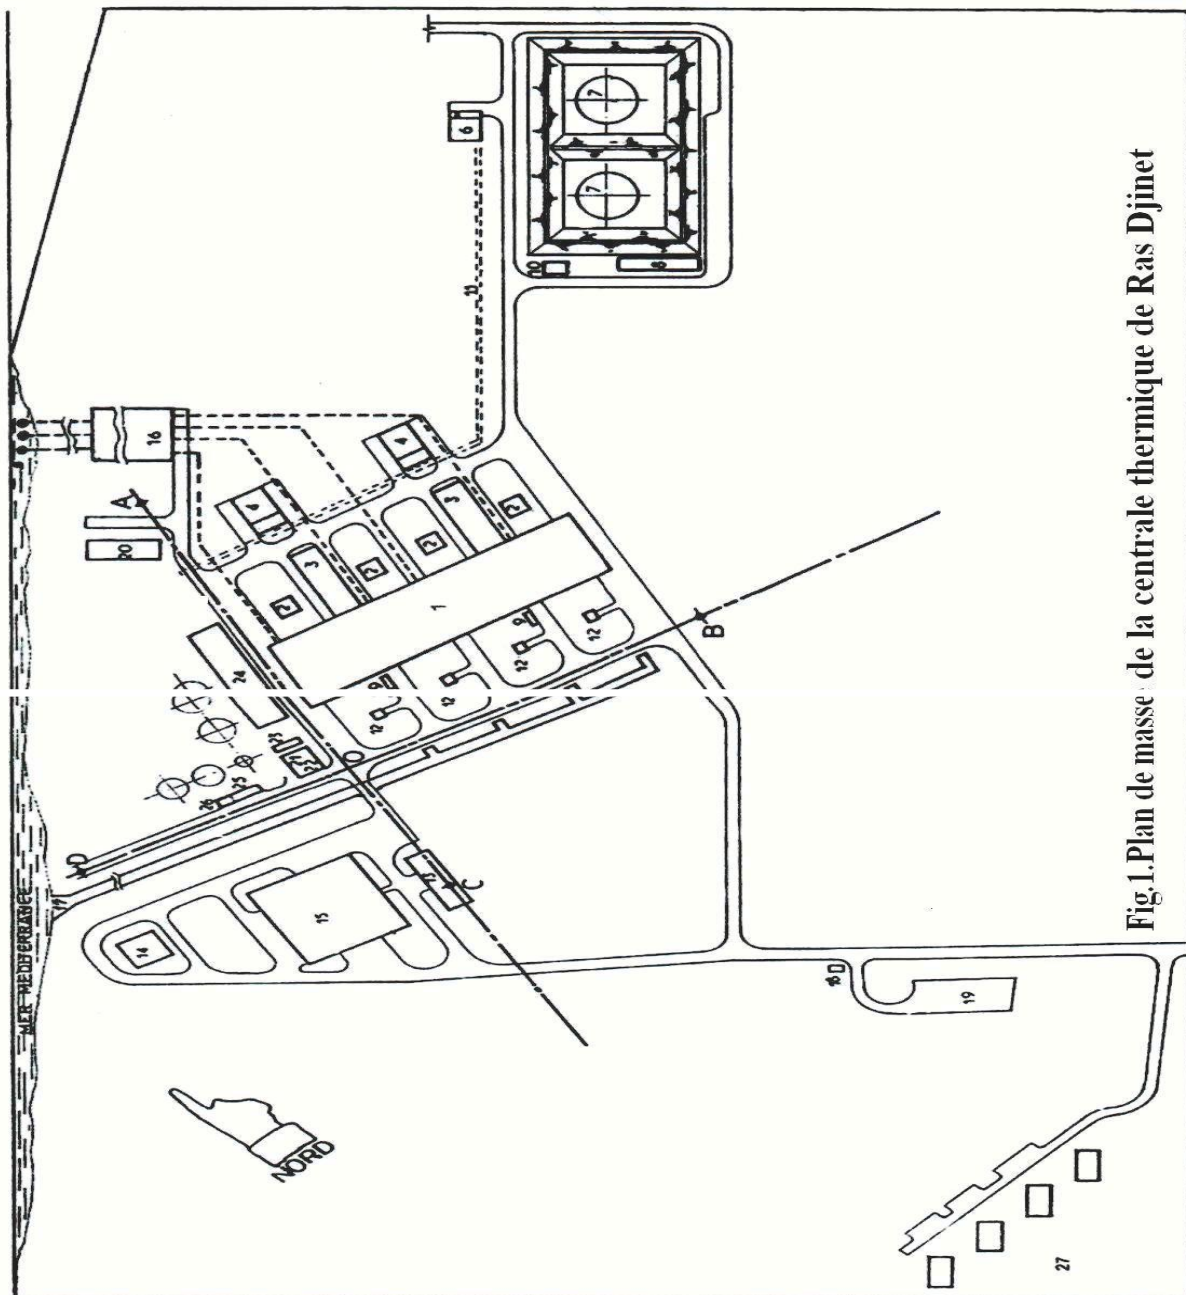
Plan de masse de la centrale de RAS-DJENET
